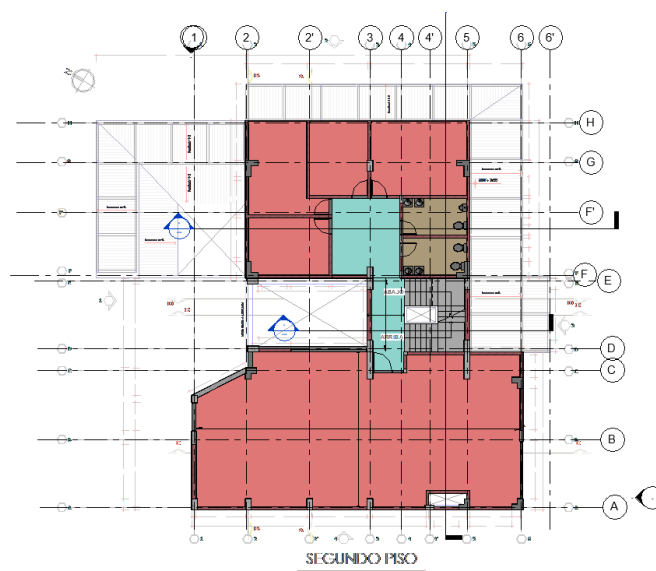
Vista en planta del modelamiento arquitectura segundo nivel
